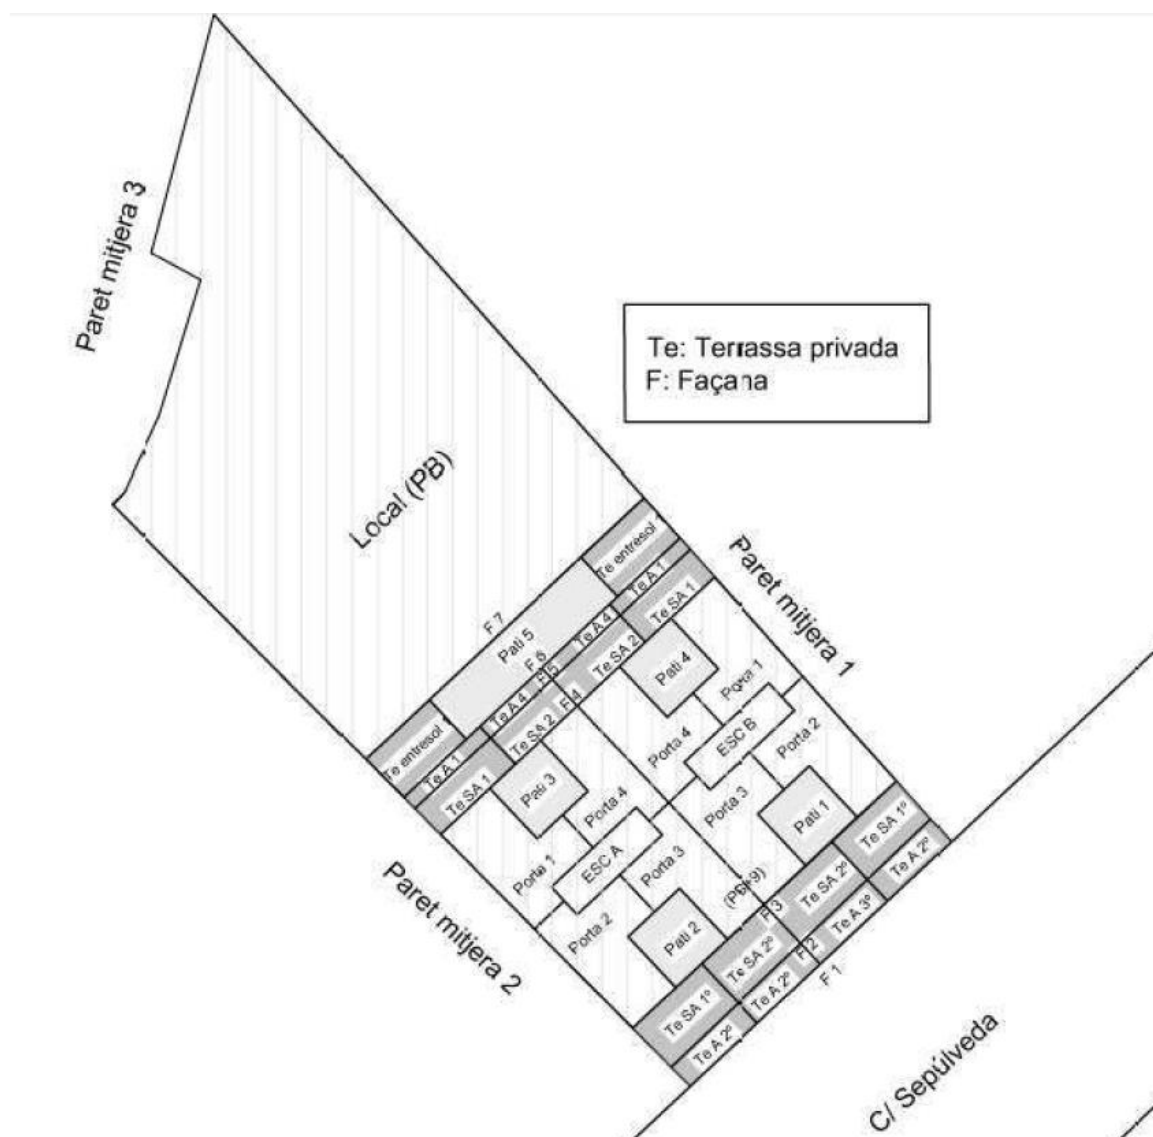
Croquis amb les diferents parts que componen l'edifici [13].
